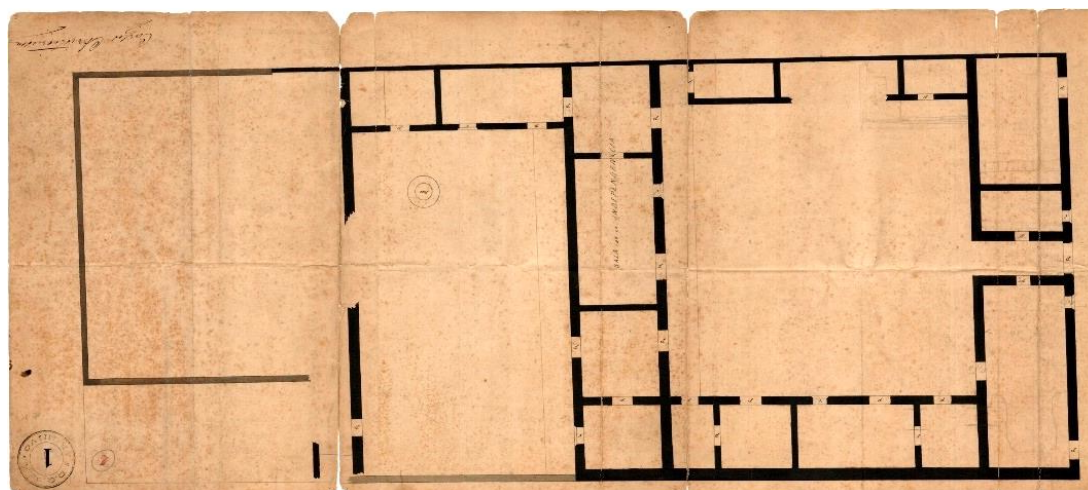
Relevamiento de 1870 Plano N° 1 DGA Carl Christiersson
